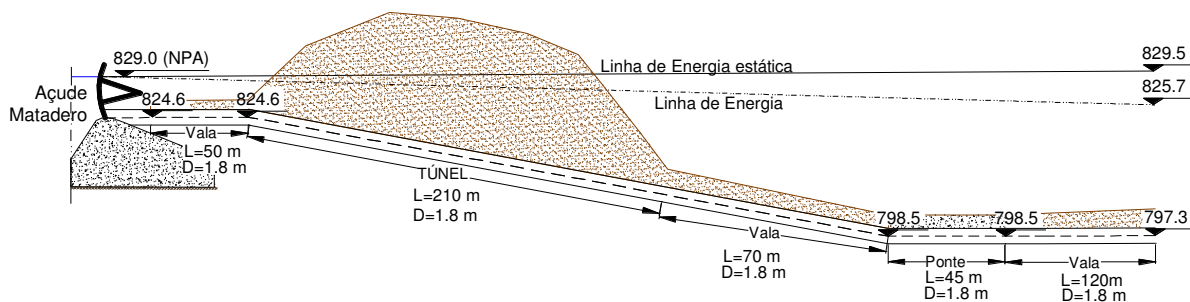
Perfil esquemático do trecho 2 da conduta (D=1.8 m) – solução 2.
